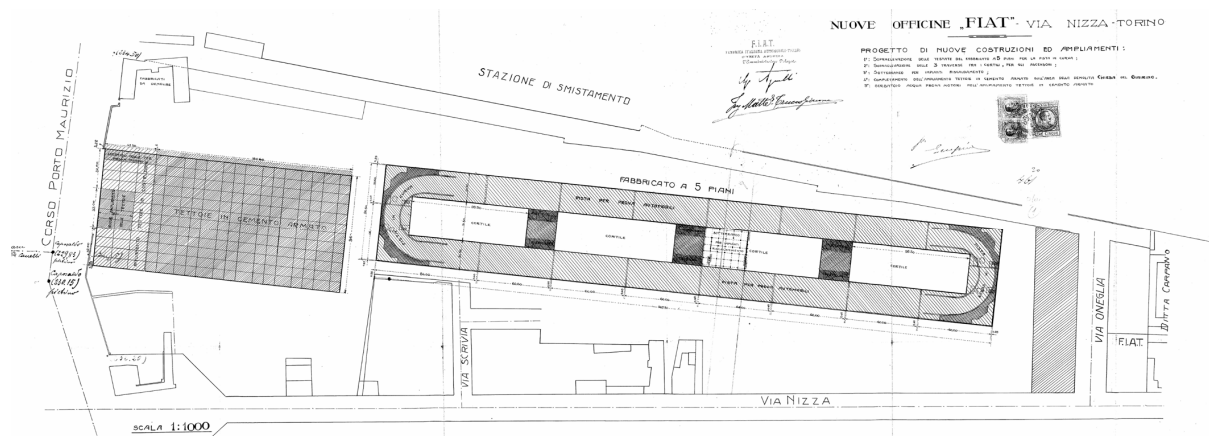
Planta geral do complexo. A planta está orientada a norte, vendo-se a oficina das carroçarias a poente e a fábrica de montagem ao centro (in AMT).
